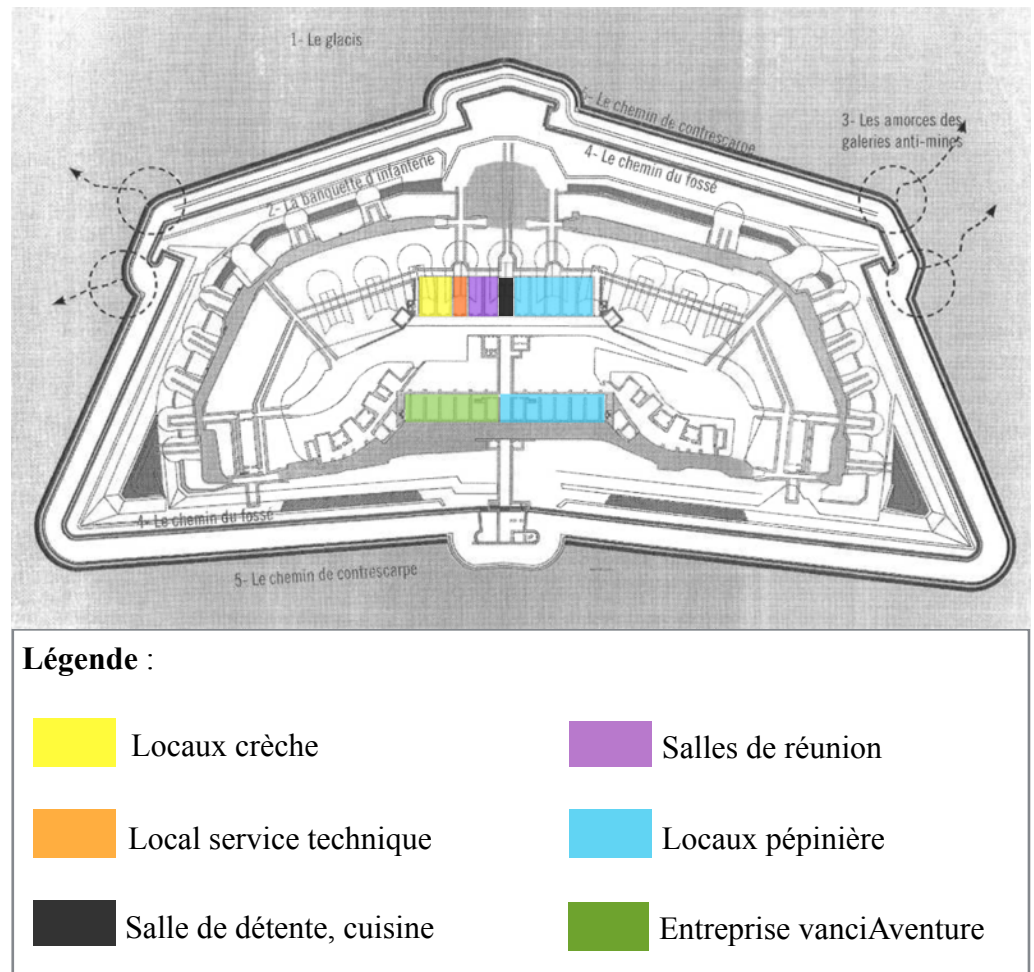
Plan d'occupation du premier étage du fort, réalisation Isaure Leotard
